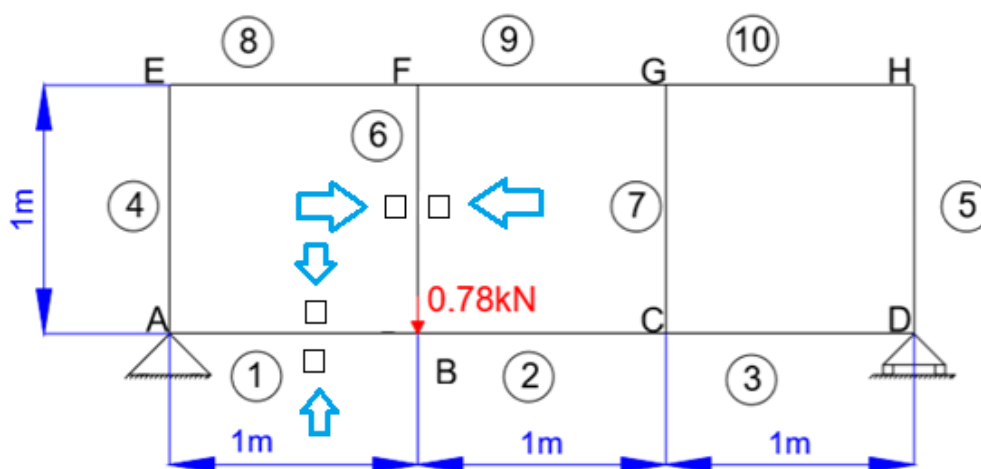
Ubicación de las galgas instaladas en la estructura.
